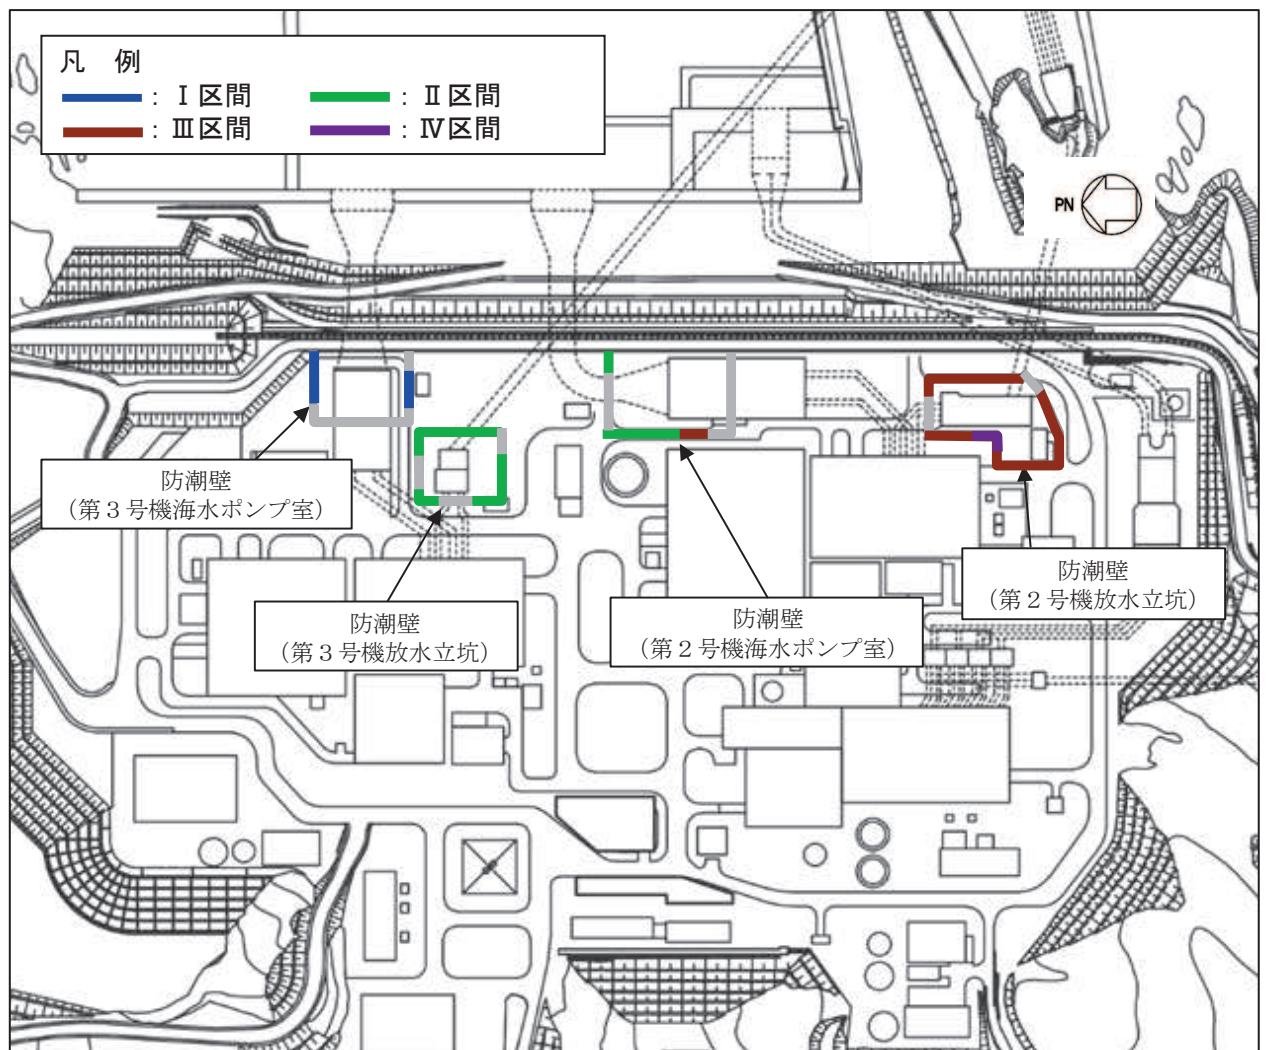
鋼製遮水壁（鋼板）の区間配置図
